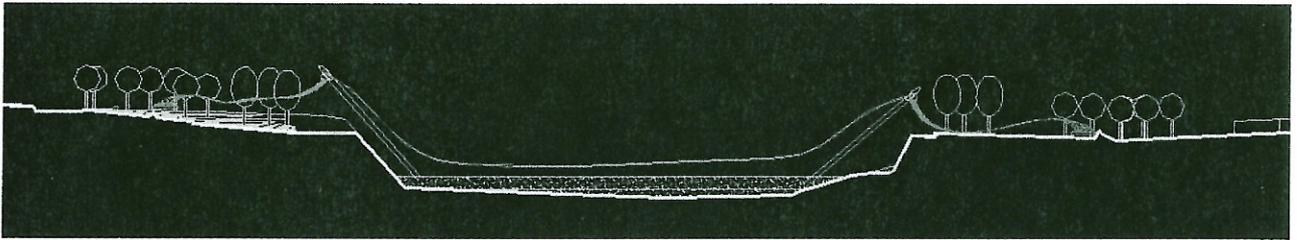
Fase 2: Predisposizione dei cavalletti di ancoraggio, degli stralli di ancoraggio e distensione delle funi portanti
